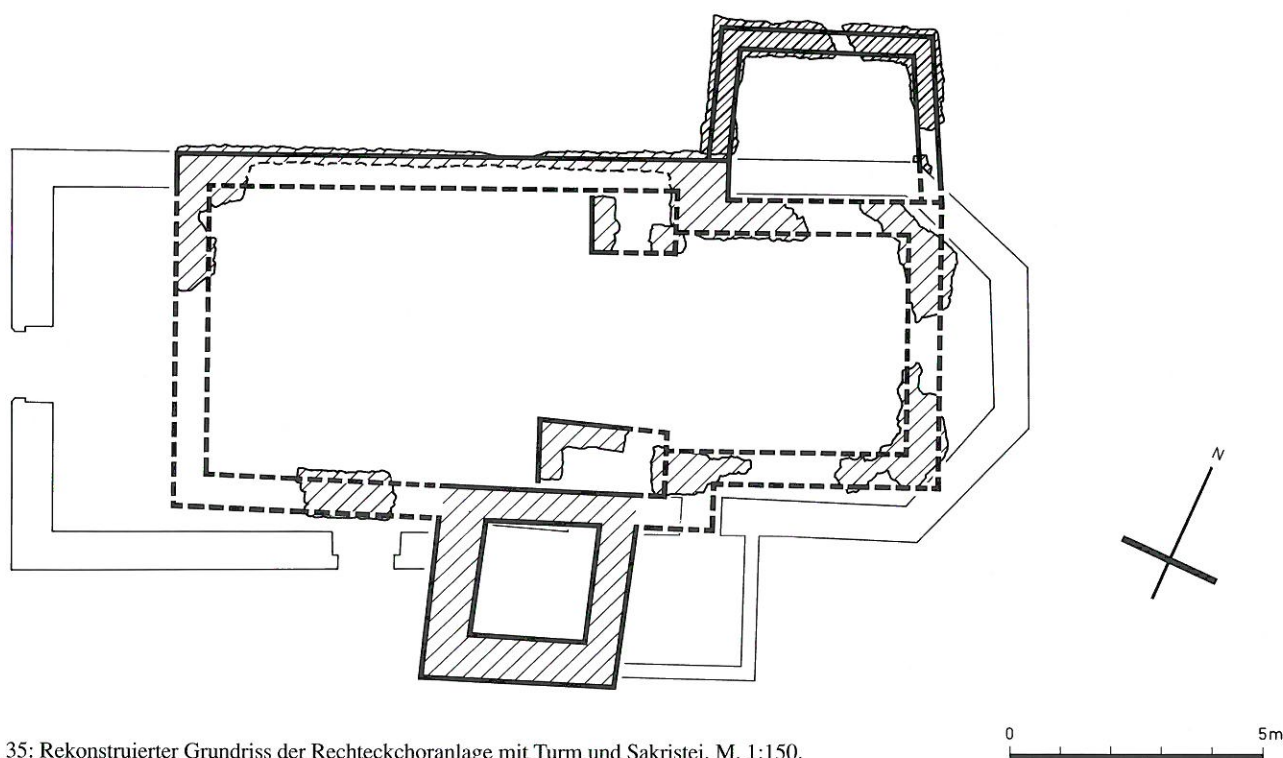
Rekonstruierter Grundriss der Rechteckchoranlage mit Turm und Sakristei. M. 1:150.
